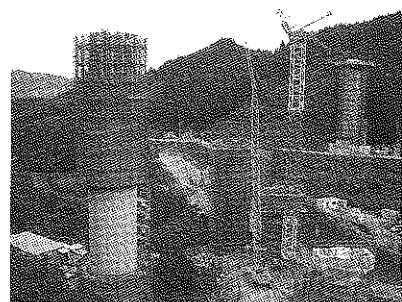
三瀬トンネル有料道路での施工状況（円形断面）
